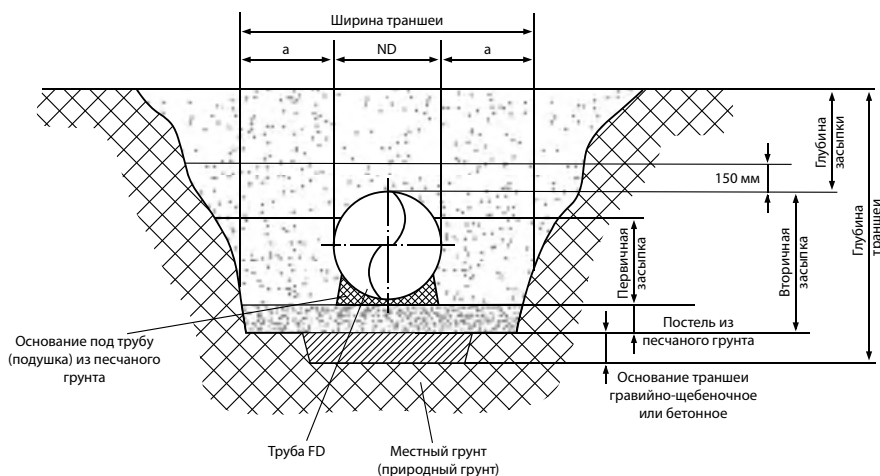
Схема укладки трубопровода на гравийно-щебеночное или бетонное основание
